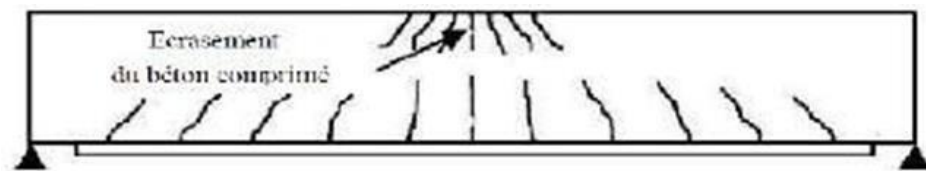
Schéma typique de poutre en BA renforcée par le collage de composite endommagée par flexion et par l'écrasement du béton comprimé.(MEBAREK and MENACER, 2022).
